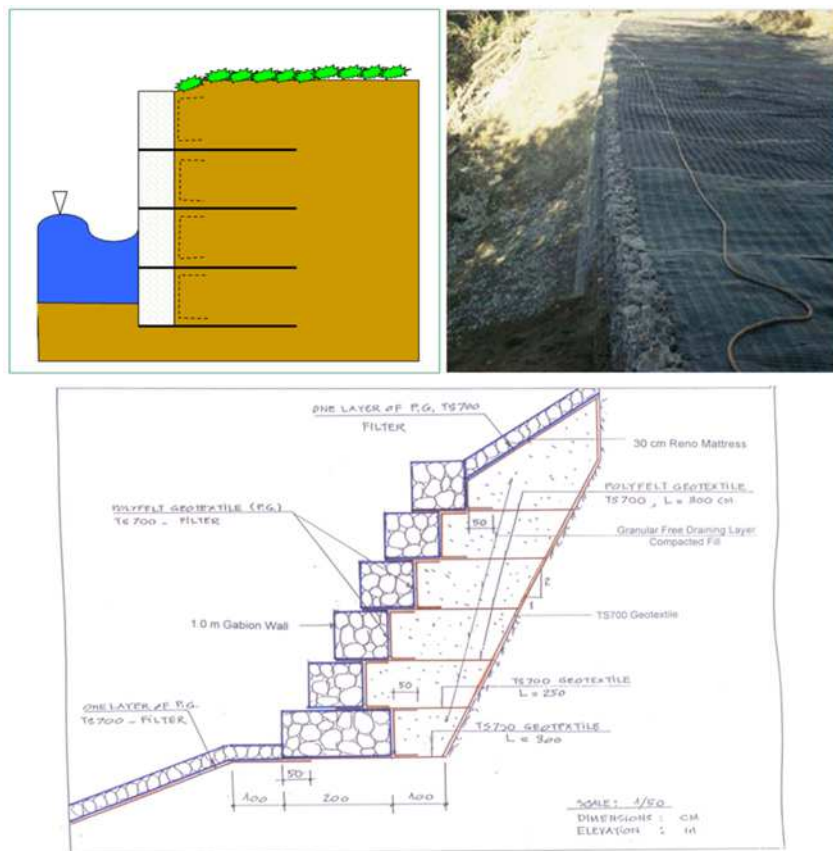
กำแพงกันดินแบบ Gravity Wall
